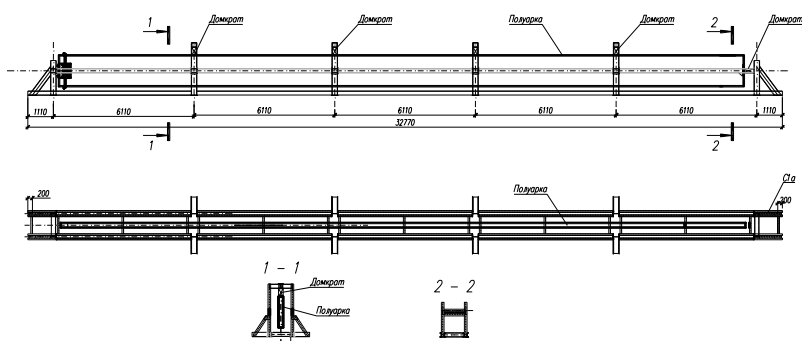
Установка для испытания в натуральную величину клееных деревянных балочных элементов арки треугольного очертания
